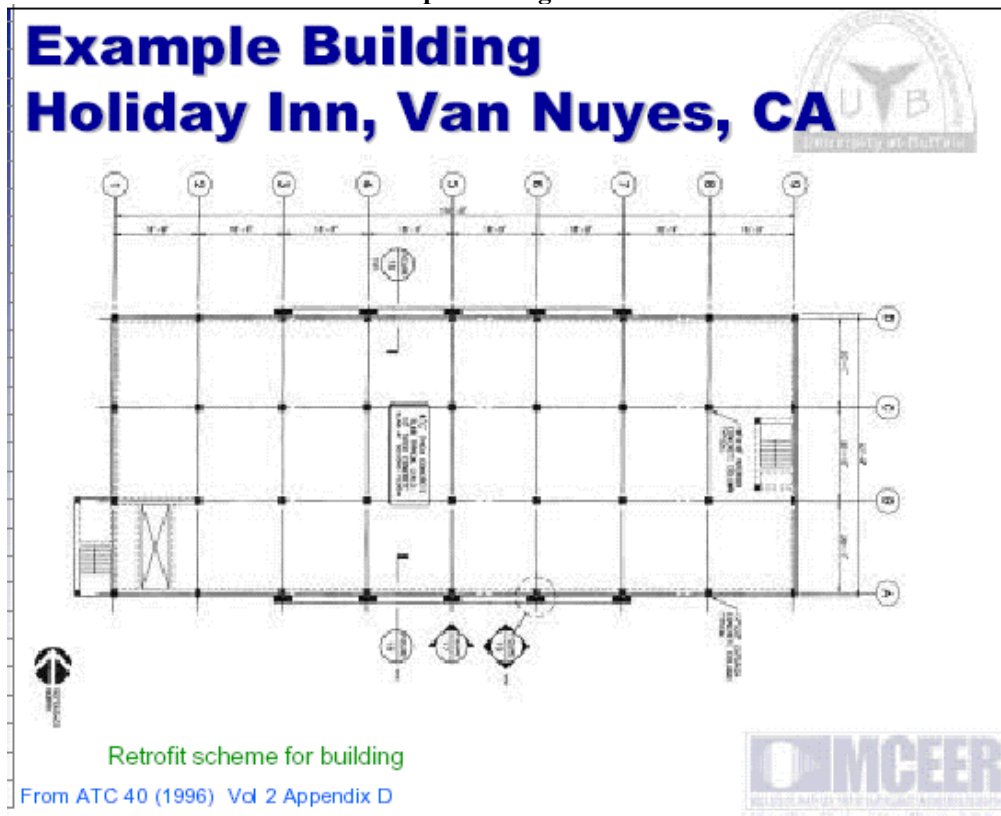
Mejoramiento sistemático para el edificio en las fachadas (plano en planta).
